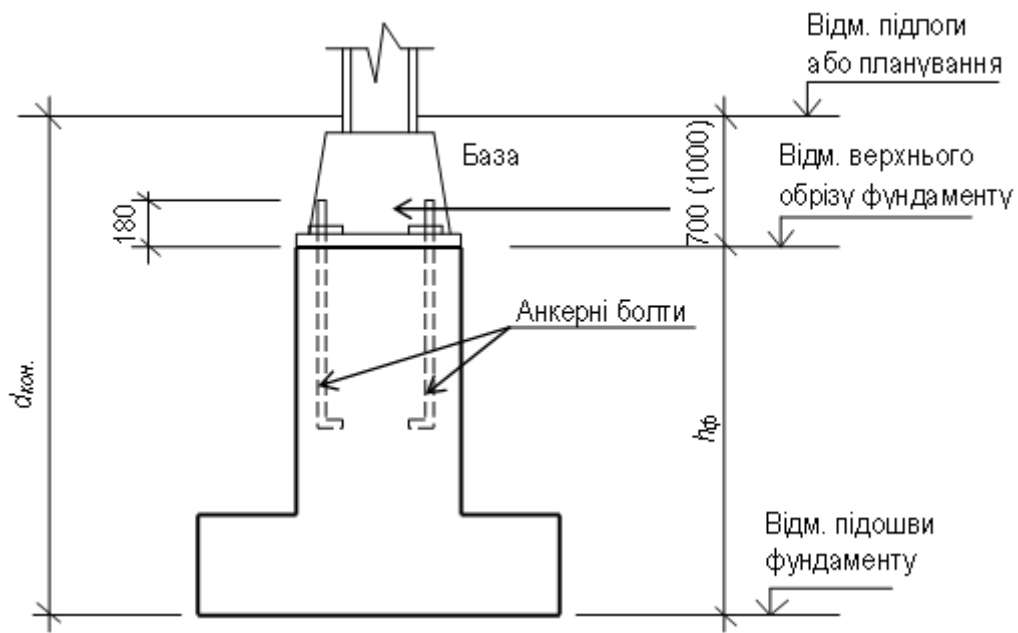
Попереднє конструювання окремого (стовпчастого), монолітного фундаменту під металеву колону (без підвалу)
